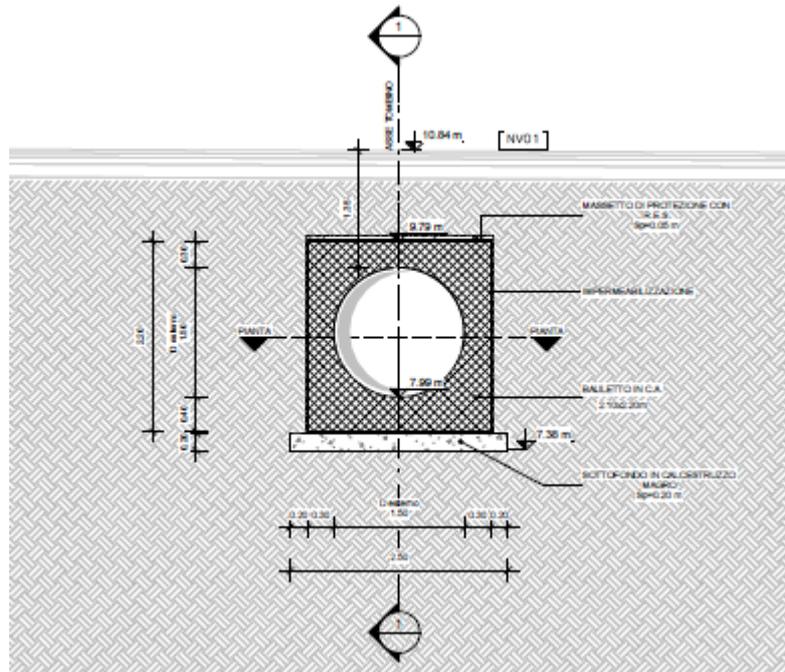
IN05-IN06 tombino stradale circolare – sezione trasversale
